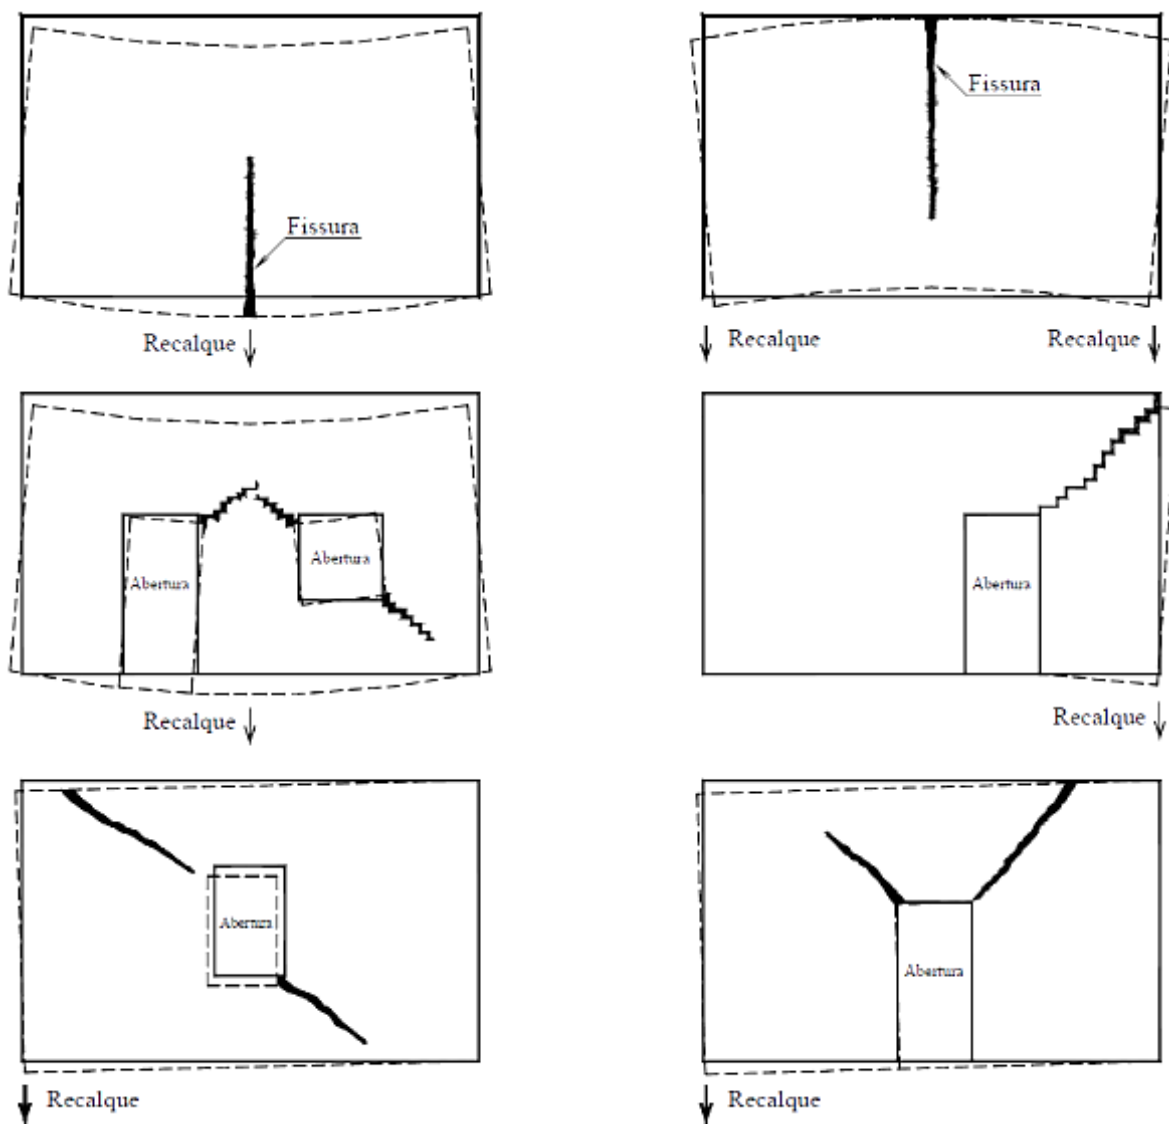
Diversos tipos de fissuras causadas por recalques
